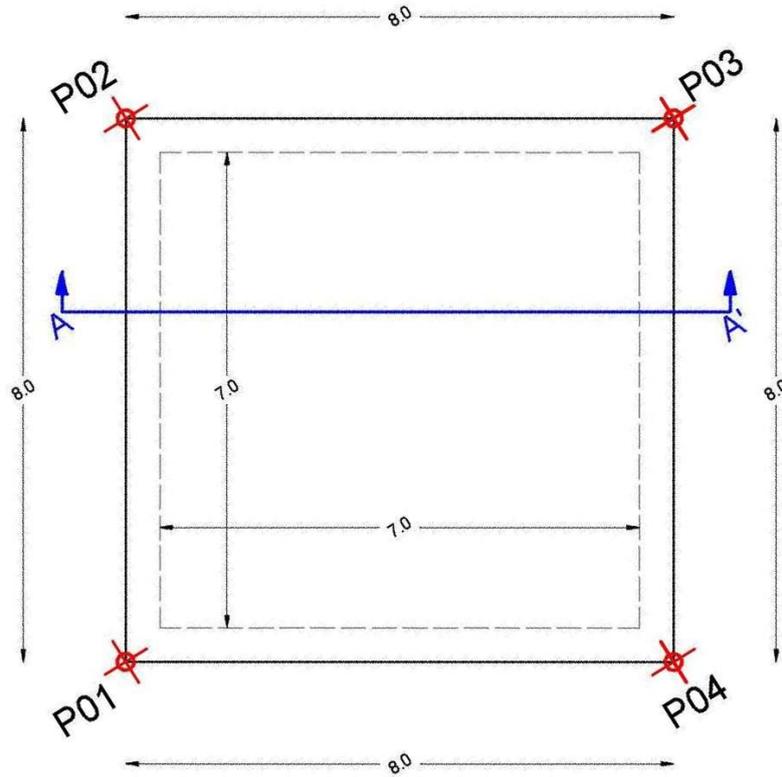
Planimetria dello scavo per la realizzazione delle fondazioni
